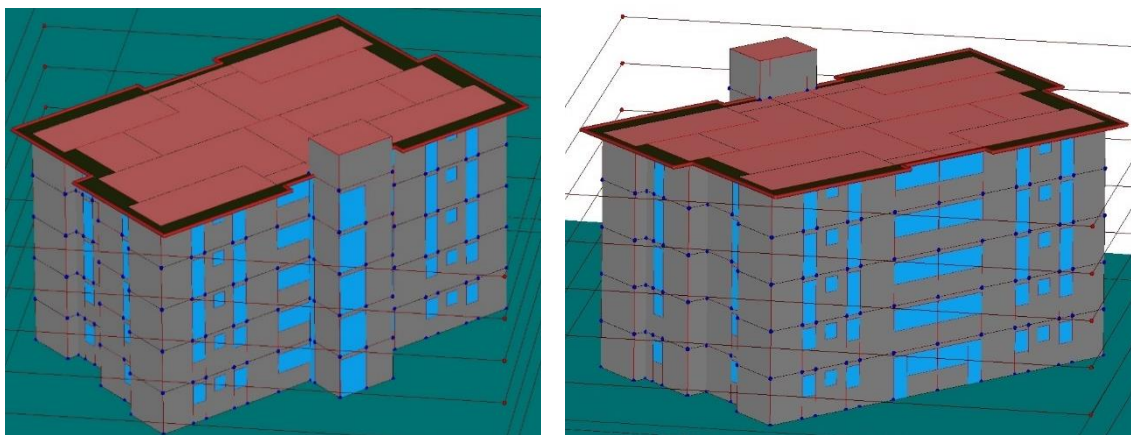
Planimetría EA de la envolvente térmica. Fuente: Elaboración propia.
